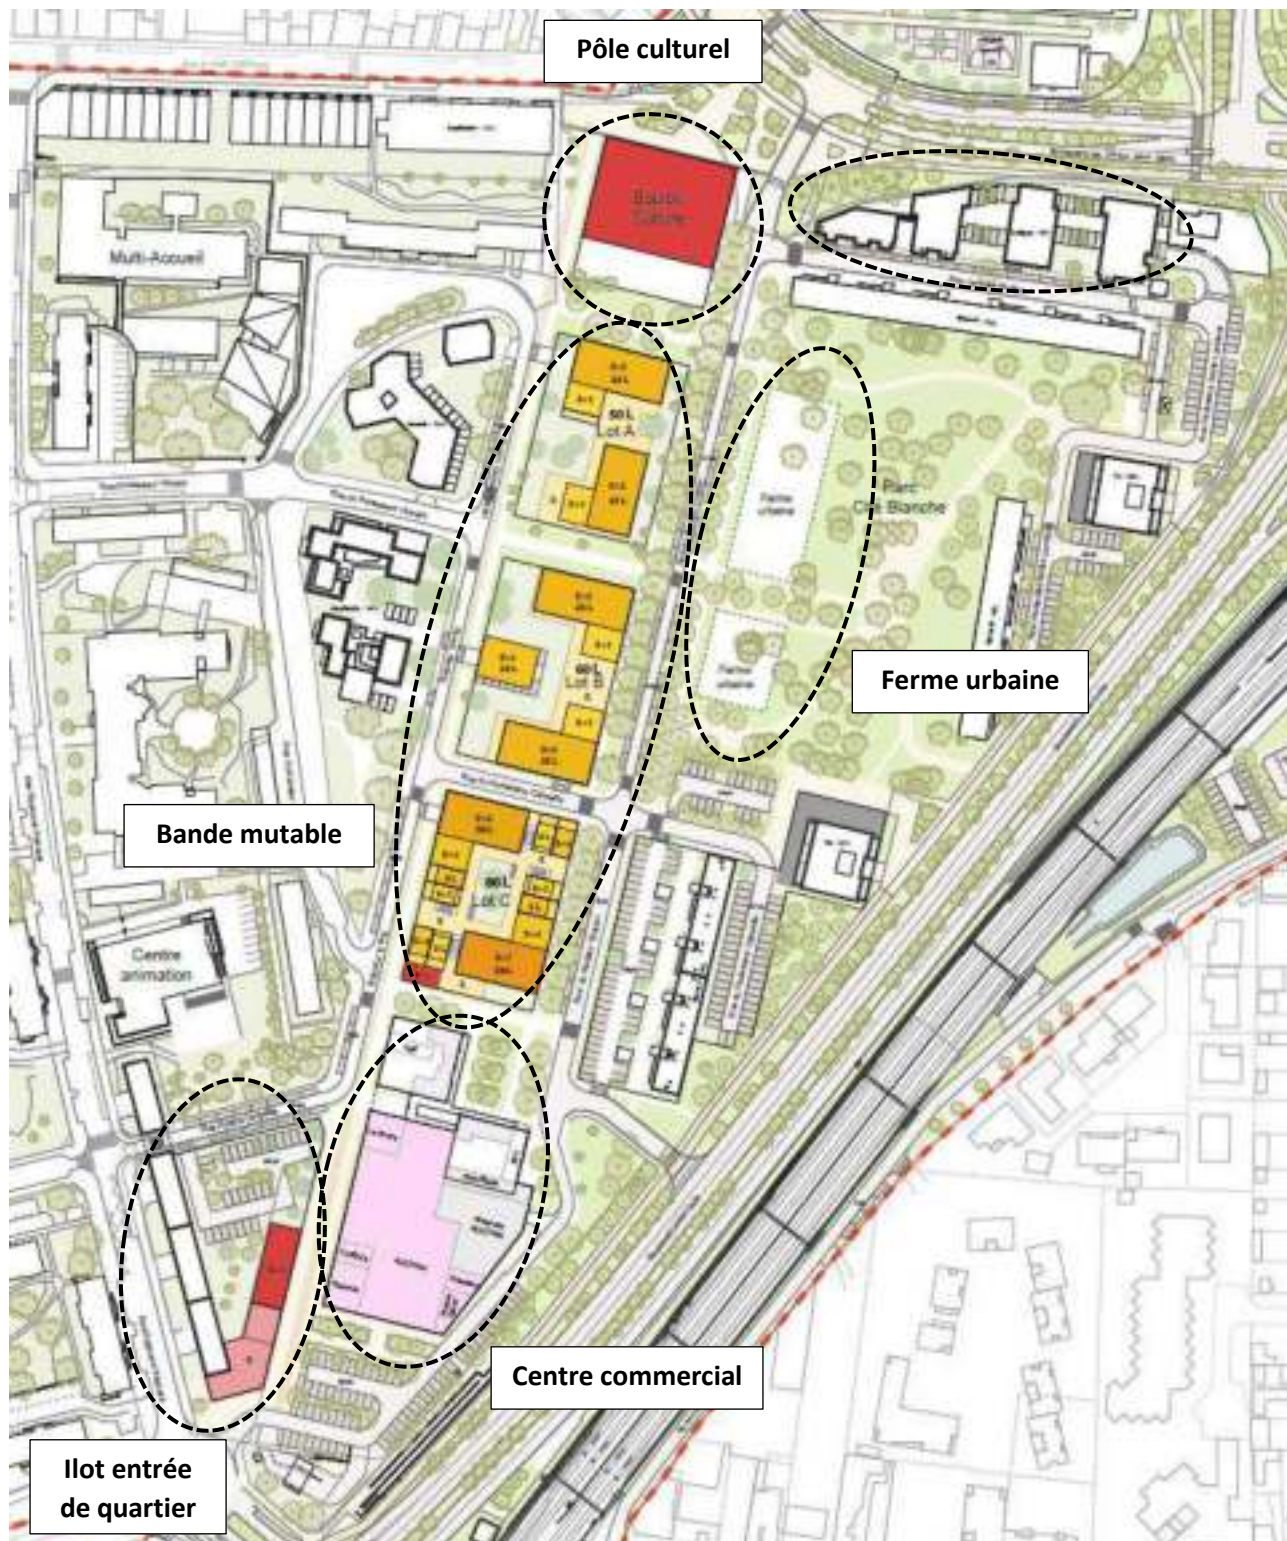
Plan guide - Zoom sur le secteur Pinson - Cité Blanche
